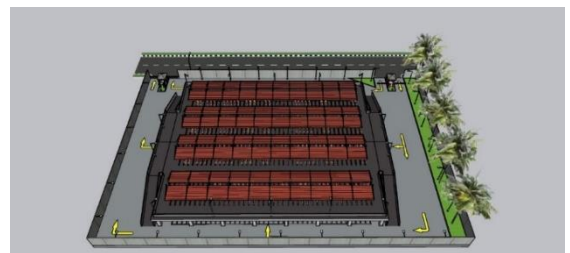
Visualisasi 3D Desain Bangunan Parkir
